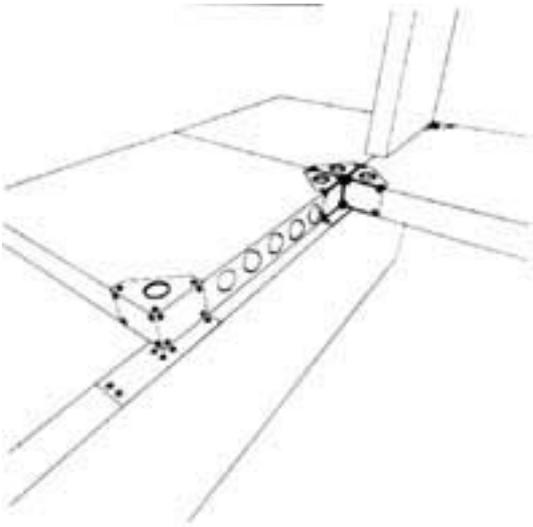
Denkbare Deckenanschluß bei einem Wandsystem⁷⁰⁶
